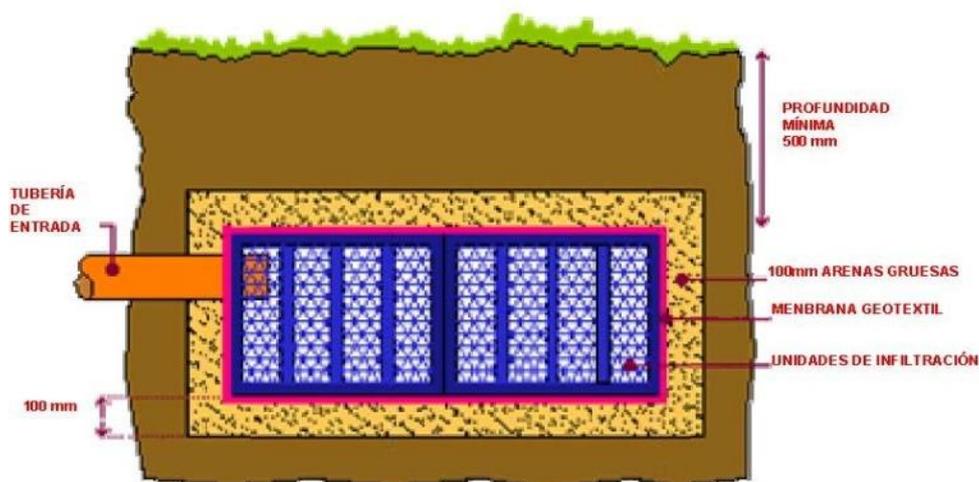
Rejilla de infiltración en calles del conjunto del Proyecto
